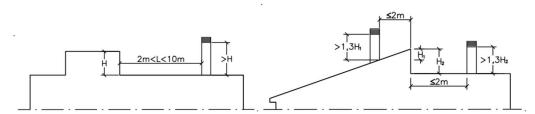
Ejemplos de altura libre del extremo superior de la bajante sobre la cubierta
